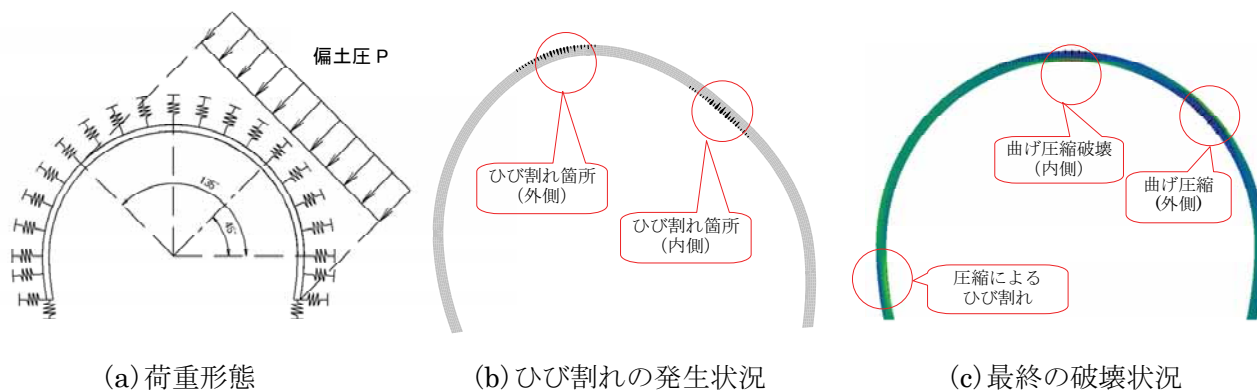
偏土圧が作用する場合のひび割れ図および変形図
